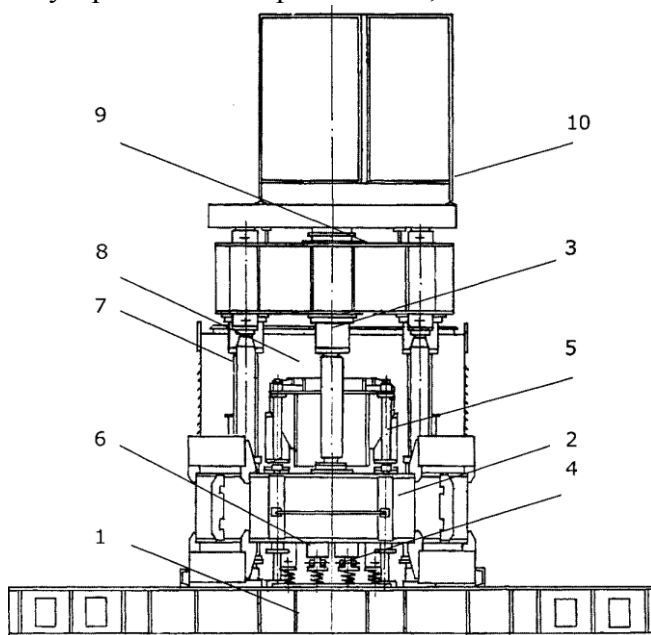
Гидравлическая свиевдавливательная машина СО-450. Общая схема: 1 - рама грузовая; 2 - вдавливающая головка; 3 - гидроцилиндры главные; 4 - гидроцилиндры возвратные; 5 - гидроцилиндры поджима клиньев; 6 - клиновое устройство; 7 - колонны; 8 - гидропривод установки; 9 - площадка верхняя; 10 - ограждение верхнее.
